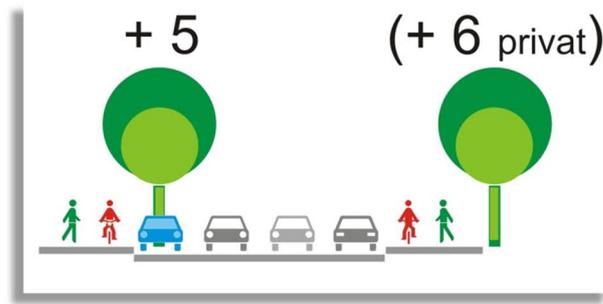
Abschnitt E – Baumbilanz (Klammerwert: auf privaten Grundstücken)
